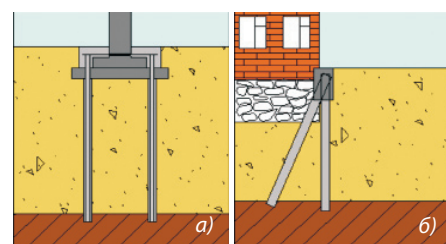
Схемы усиления фундаментов буроинъекционными сваями: а) усиление ленточных фундаментов здания; б) усиление отдельно стоящего фундамента
